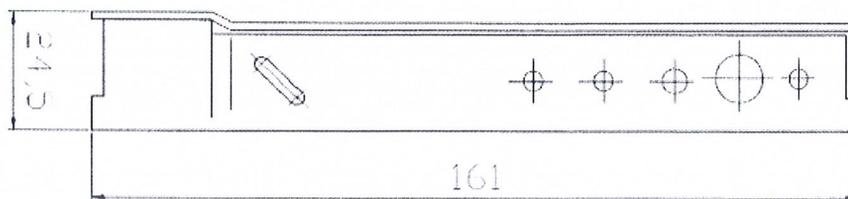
Verankerungselement für Stahlürrahmen in Mauerwerks- und Stahlbetonwänden
